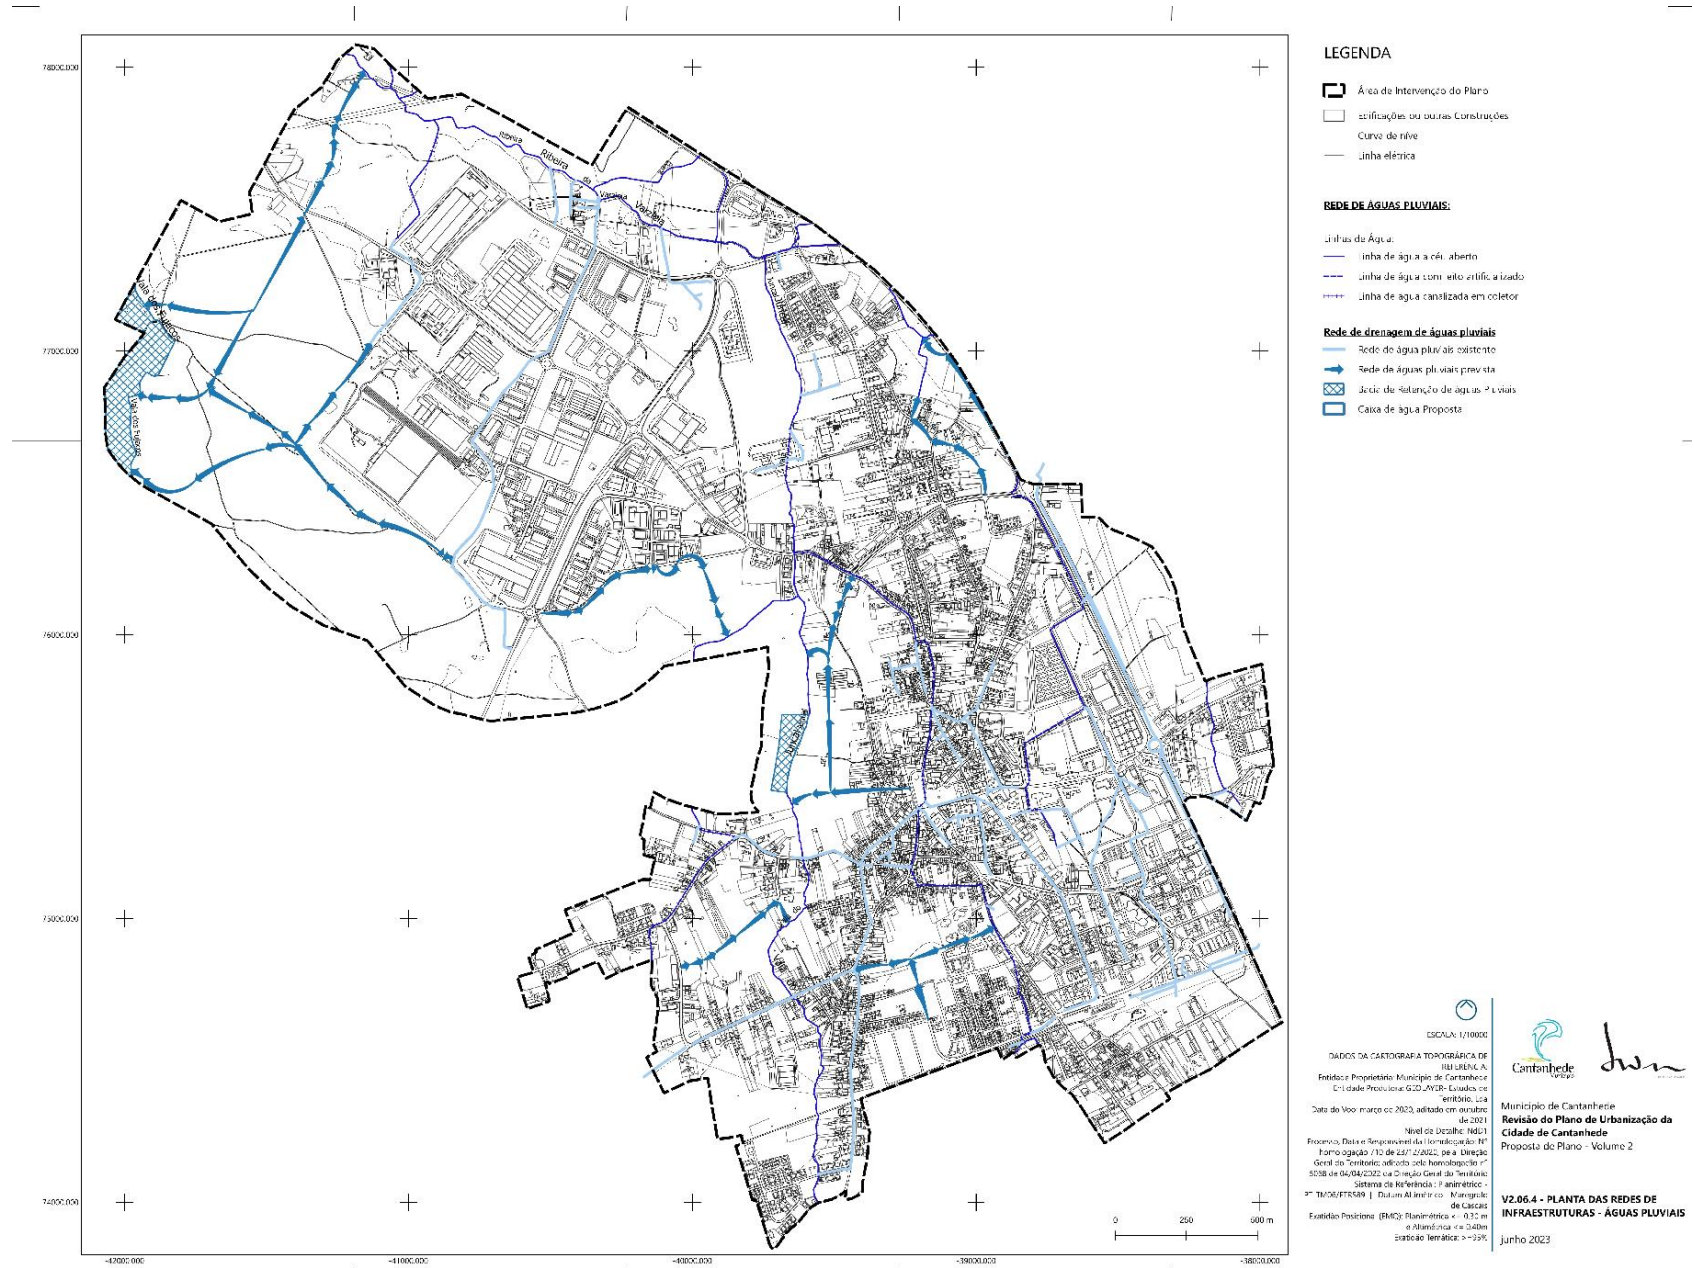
Infraestruturas existentes e propostas – redes de abastecimento de águas, drenagem de águas residuais e pluviais
